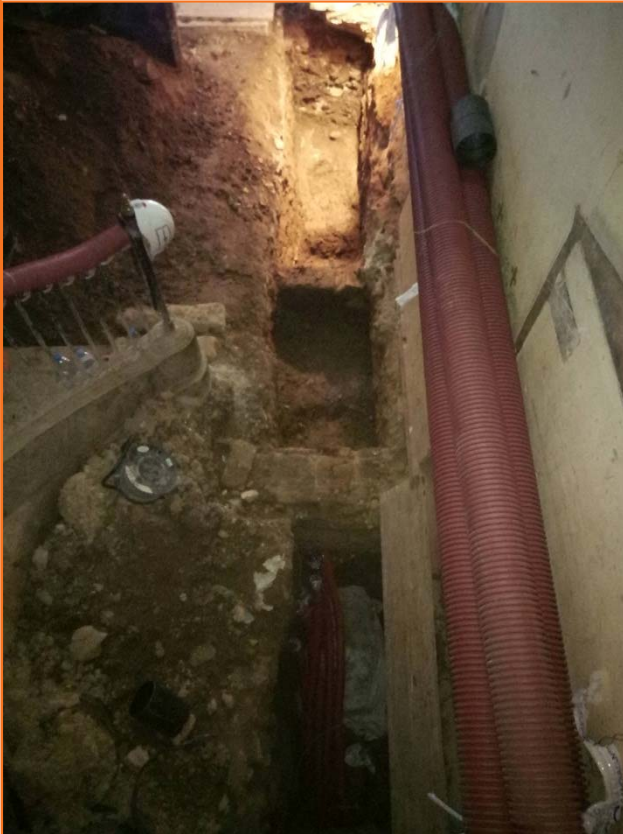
Vista de la claveguera UE 215 i del mur UE 228 i l'estructura UE 222. Passadís.
